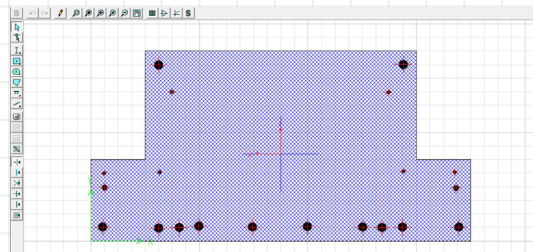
modellazione della sezione della trave TI interpiano con l'opzione "section designer"
